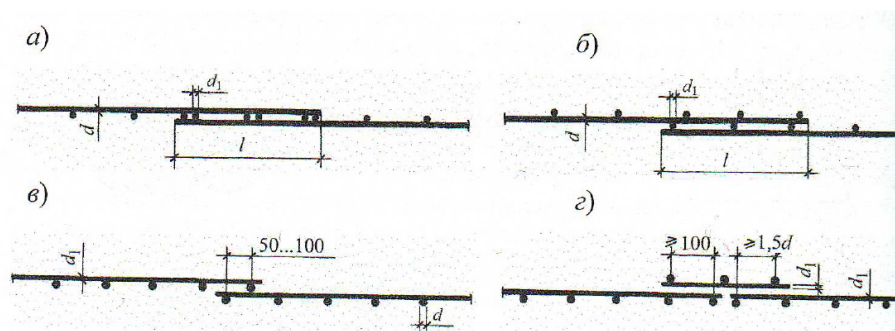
Различные способы соединения плоских сеток внахлестку: а – рабочие стержни расположены в одной плоскости; б – рабочие стержни расположены в разных плоскостях; в – перехлест распределительных стержней; г – впритык с наложением дополнительной стыковочной сетки
